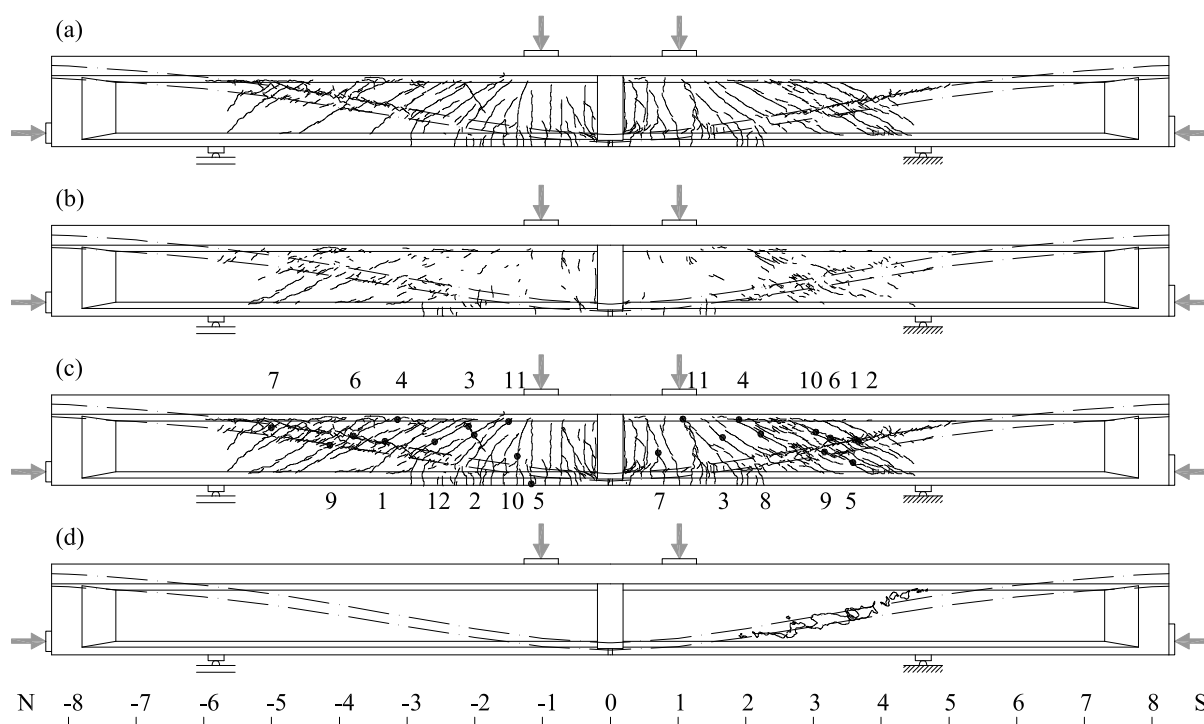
Fissuration de l'essai SH5 : (a) palier 3 (b) fissuration additionnelle entre le palier 3 et la rupture (c) rupture (d) éclatement du béton immédiatement après la rupture
